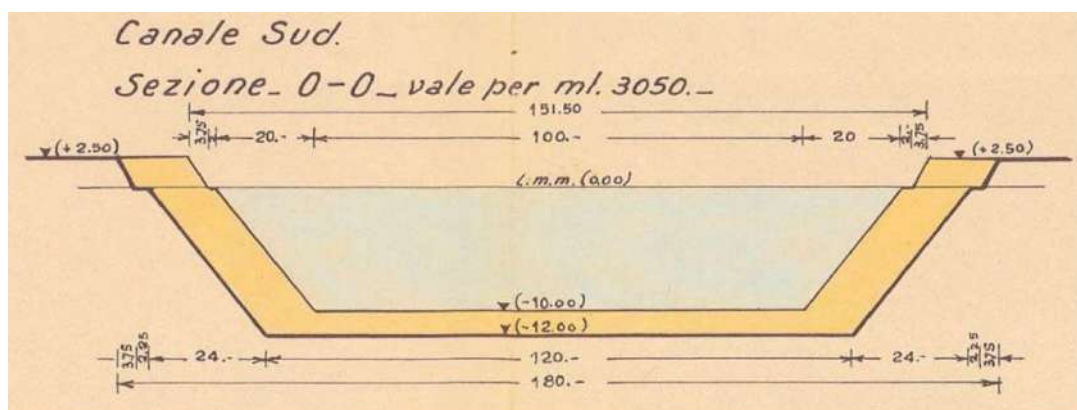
Estratto PRP 1965 - Sezione O-0
